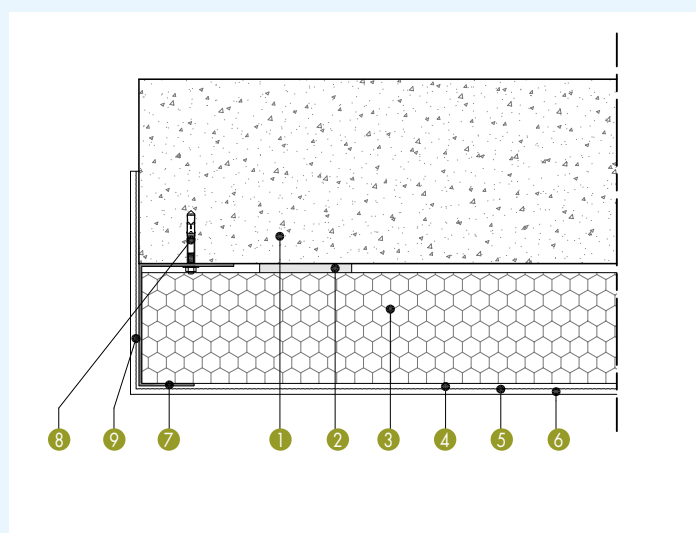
Arrêt latéral d'angle (coupe horizontale)
